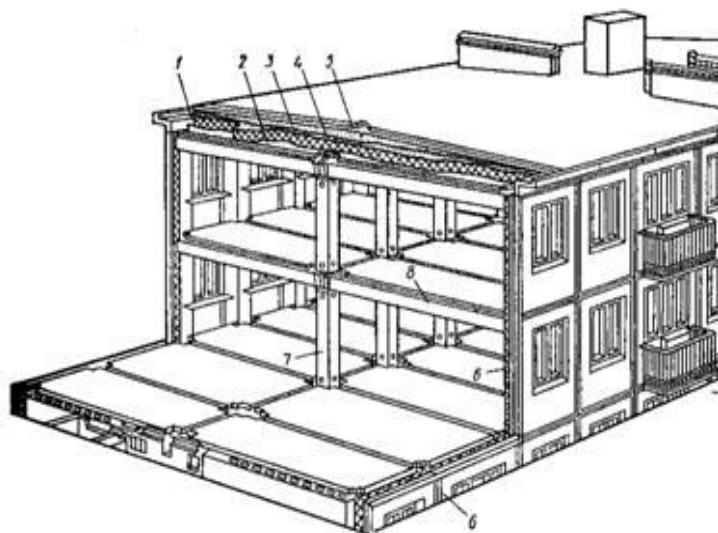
Междуэтажные перекрытия из плит заводского изготовления. Чердачное перекрытие совмещено с крышей: 1 - панель перекрытия, 2 - пароизоляция, 3 - пено- или газобетон, 4 - цементная стяжка, 5 - мягкая кровля, 6 - наружные стеновые панели, 7 - колонны каркаса здания, 8- прогоны.
